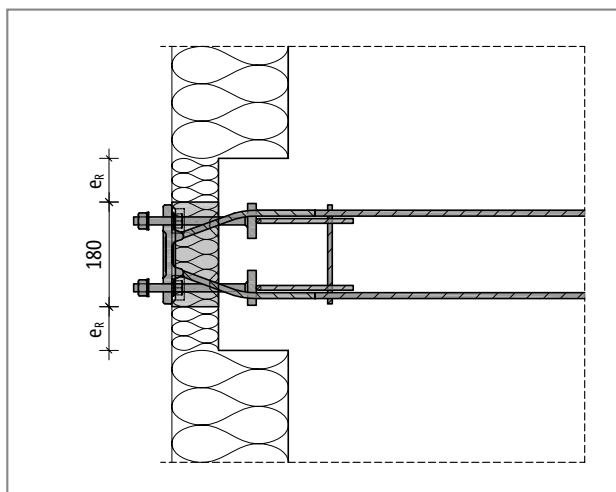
Schöck Isokorb® T tipo SQP: Distanze tra i bordi
